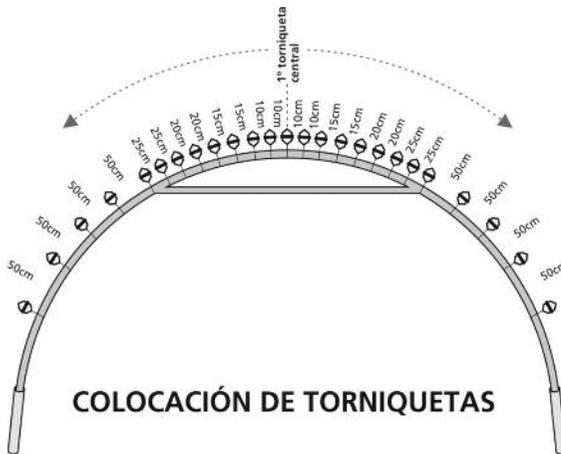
Esquema de la colocación de las torniquetas a distintas distancias en el primer arco.
